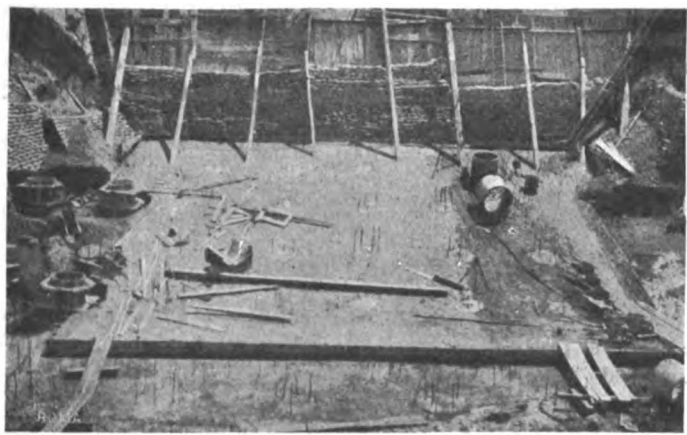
Le fondazioni Compressol sulla sponda destra.
